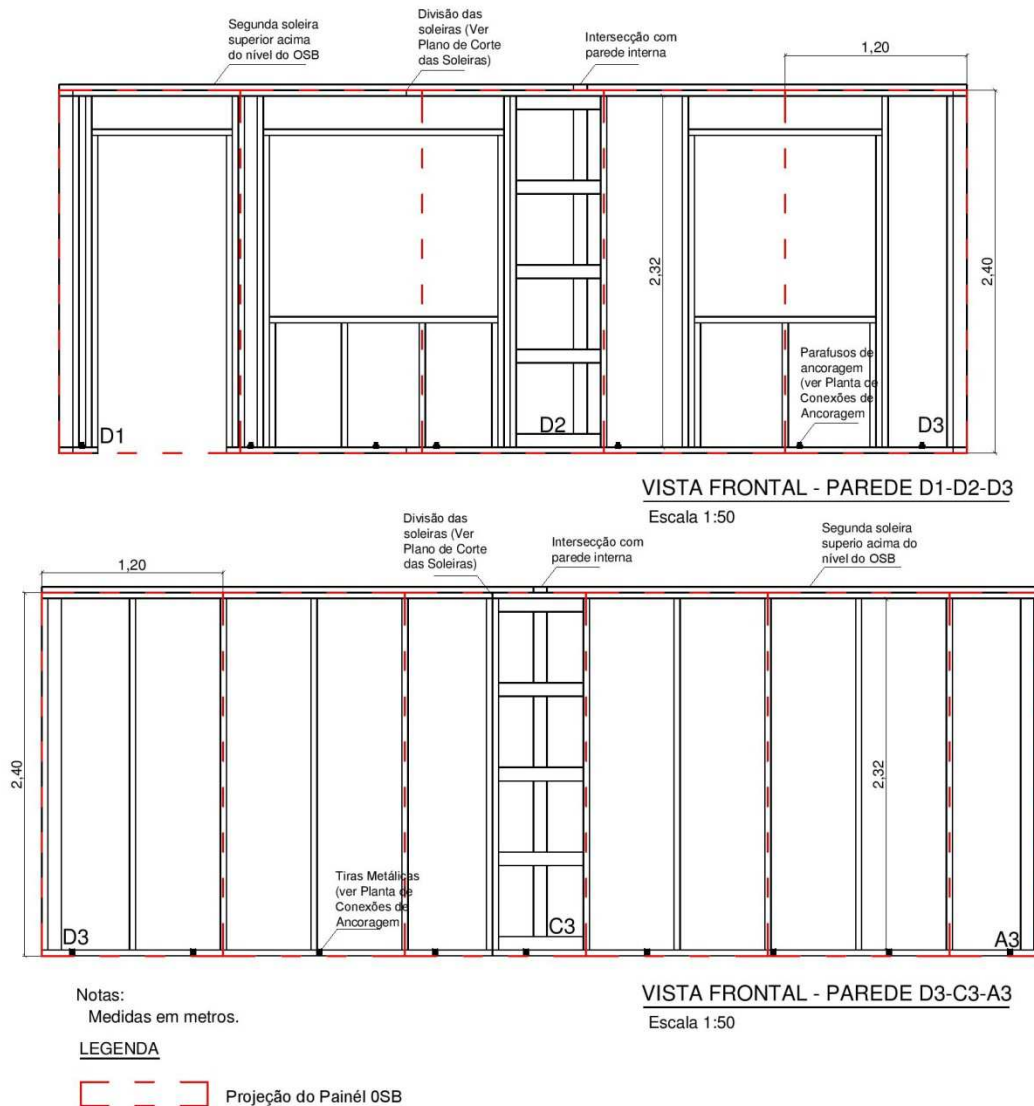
Projeto de Wood Framing: Vista Frontal de Paredes.
